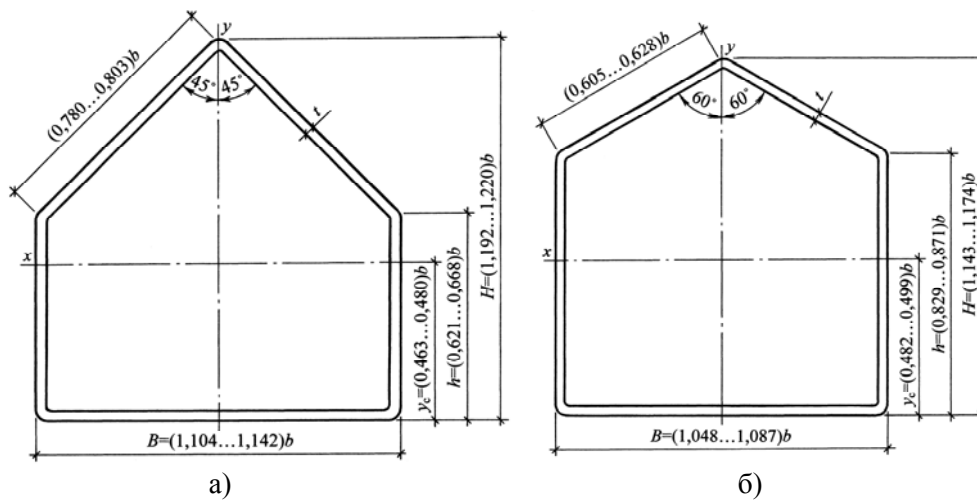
Расчетные схемы поперечных сечений пятиугольных профильных труб (гнутоварных профилей): а – с углом 90° между наклонными гранями; б – с углом 120° между наклонными гранями
